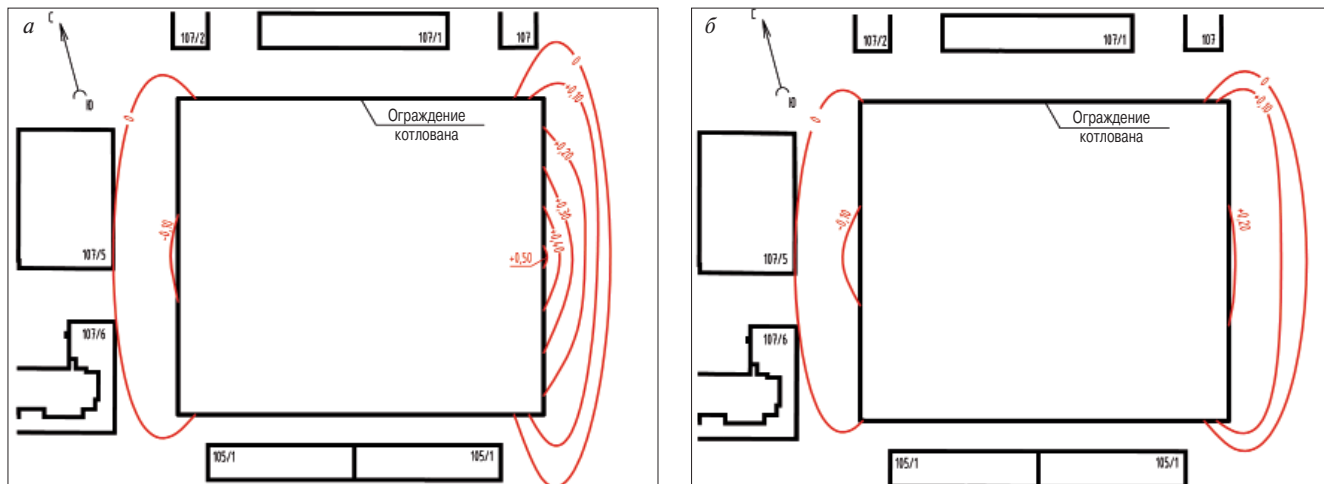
Схема изолиний изменения уровня подземных вод после устройства подземной части комплекса : а – расчетная схема 1; б – расчетная схема 2
